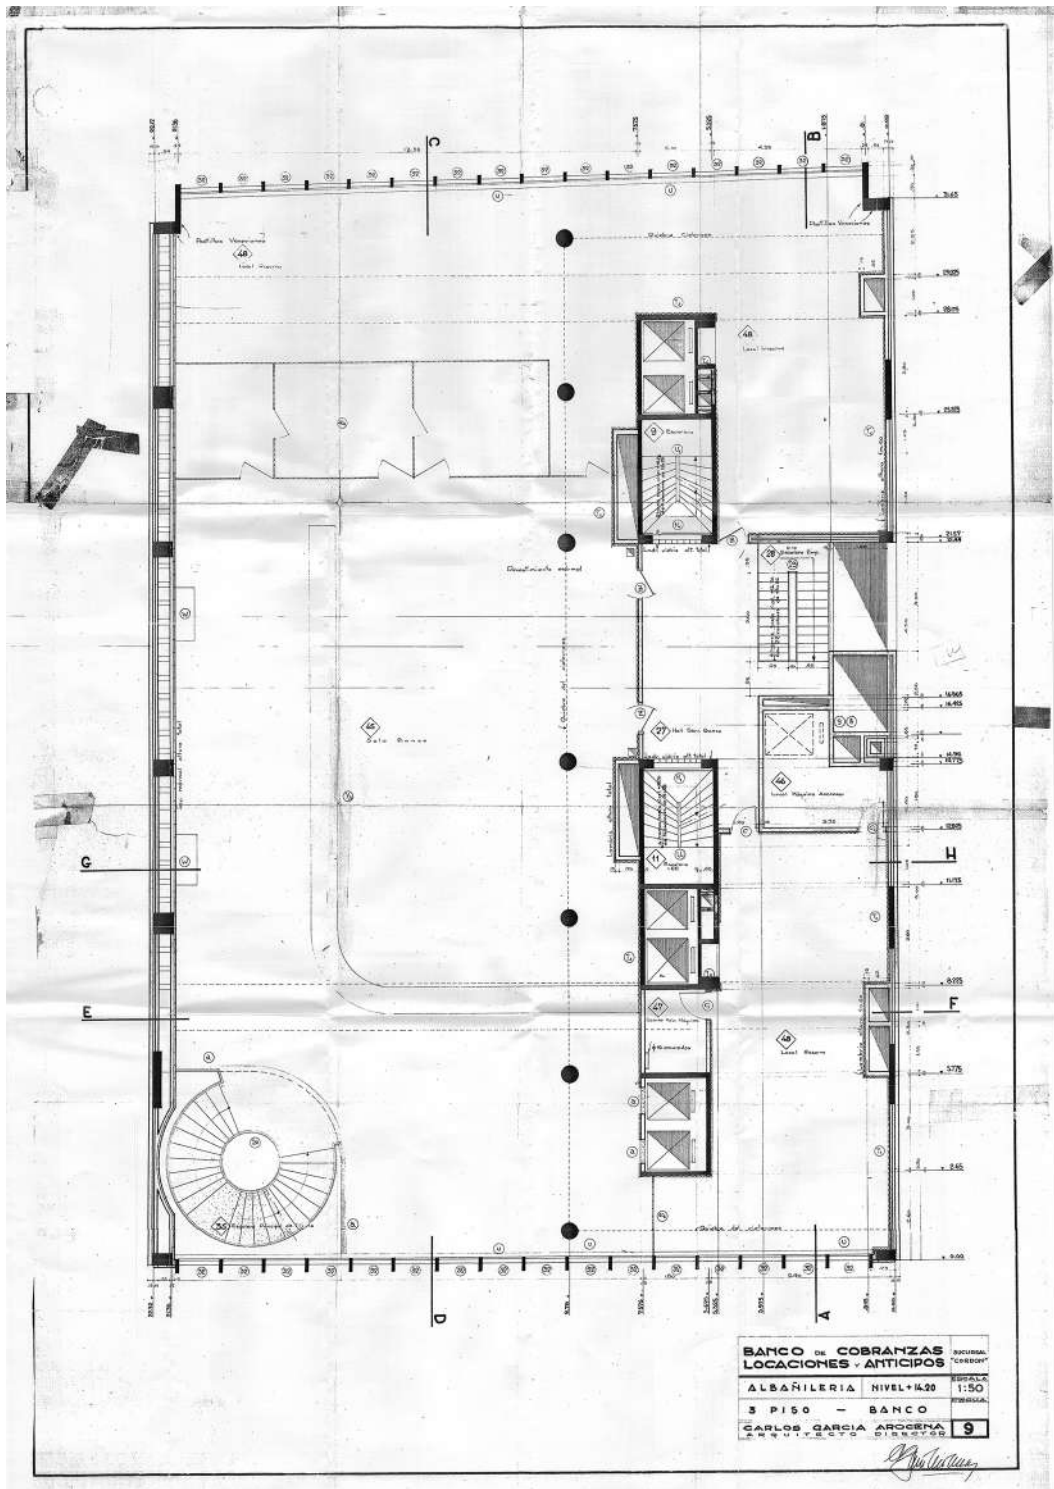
Lámina 9 del proyecto ejecutivo del BCLA: planta del piso 3.
